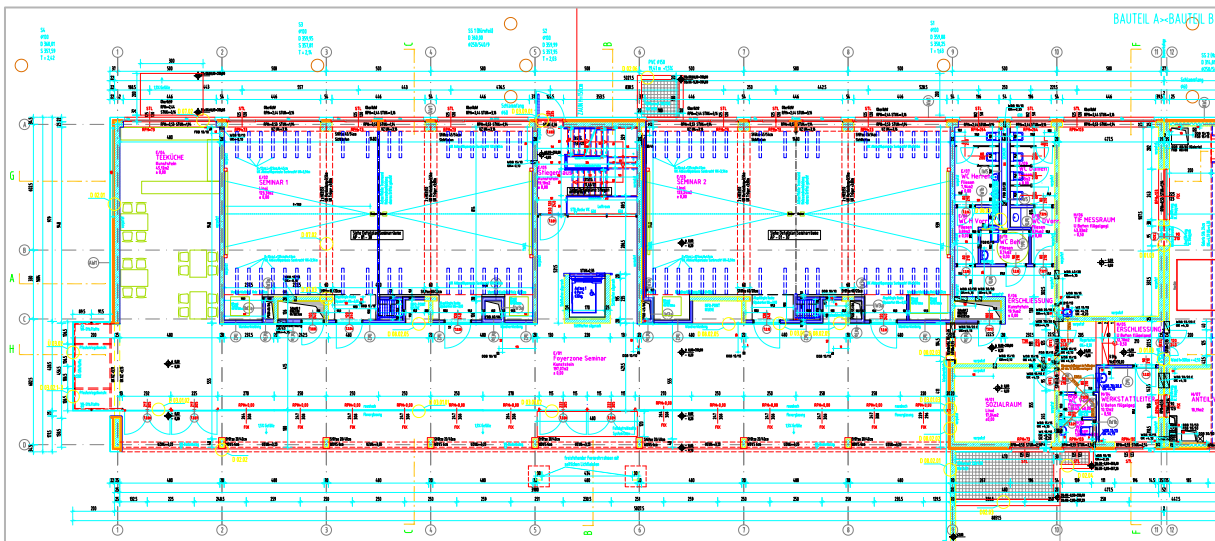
Darstellung des Grundrisses des Erdgeschosses für Bauteil A (Institutstrakt) des Frank Stronach Instituts
